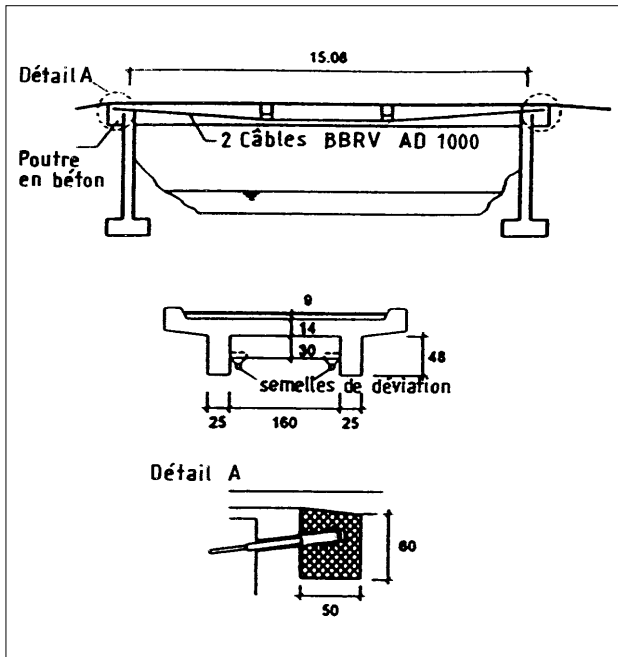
Forme de la zone d'ancrage à l'exemple du pont sur la Muota, Suisse (Müller, 1992).
